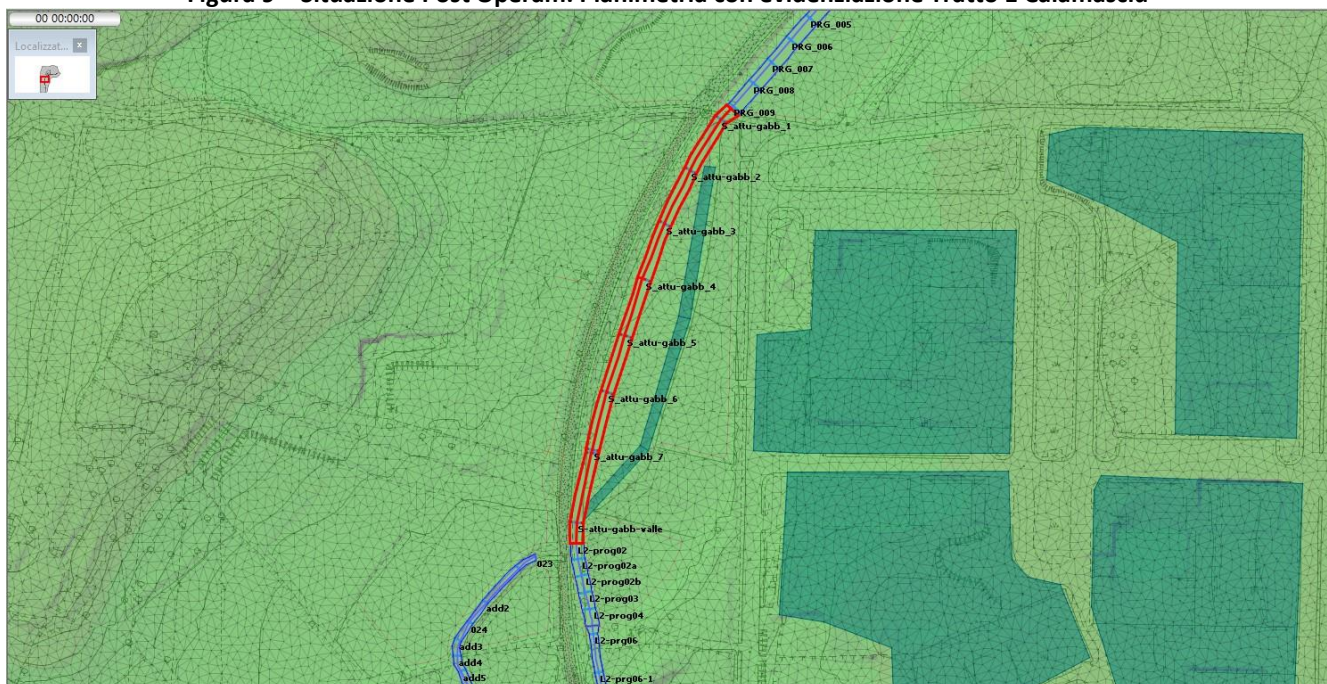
Situazione Post Operam. Planimetria con evidenziazione Tratto 2 Calamasciu
